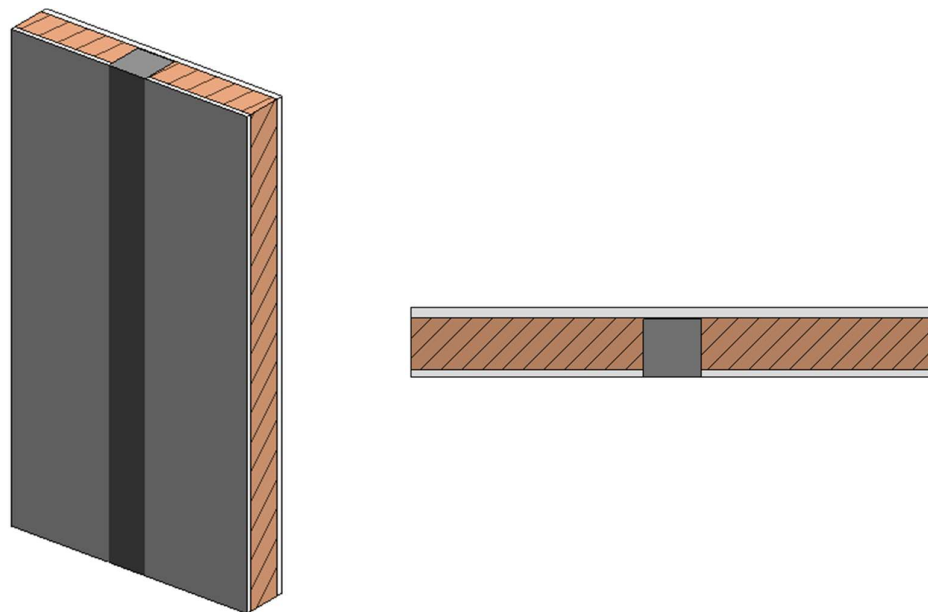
Vista en 3D y en planta del Muro 4
